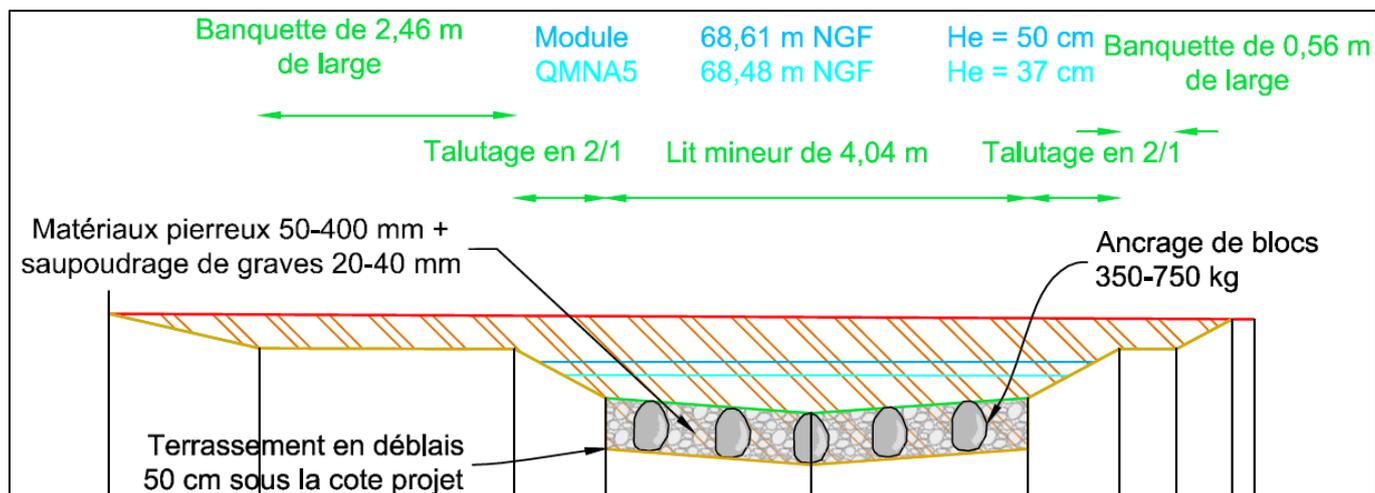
Profil en travers type au droit d'un blocage de radier (PT5)
